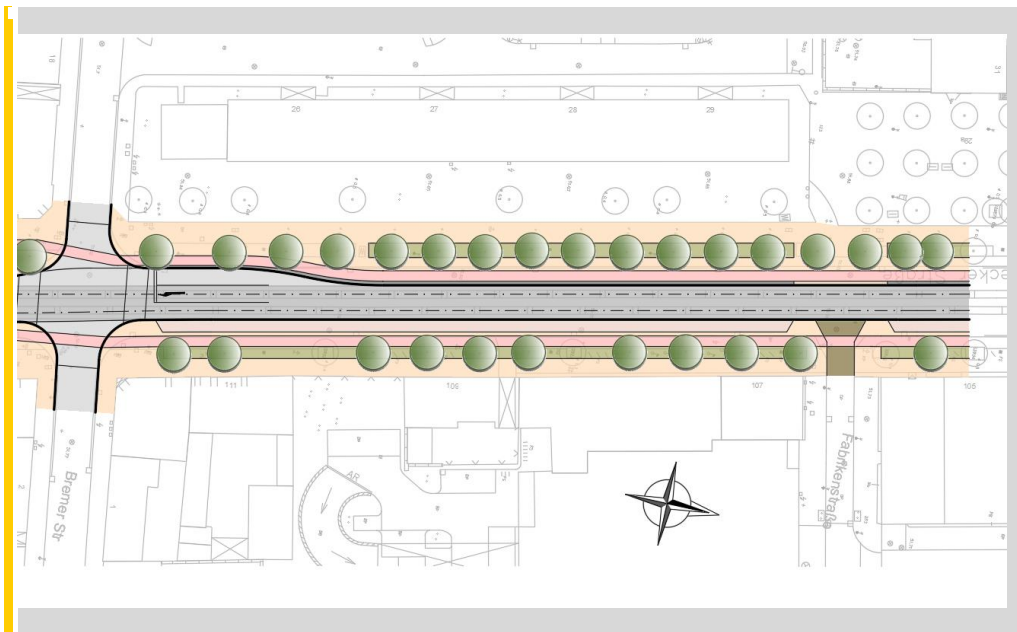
Lübecker Straße Nord, Lageplanausschnitt V2
